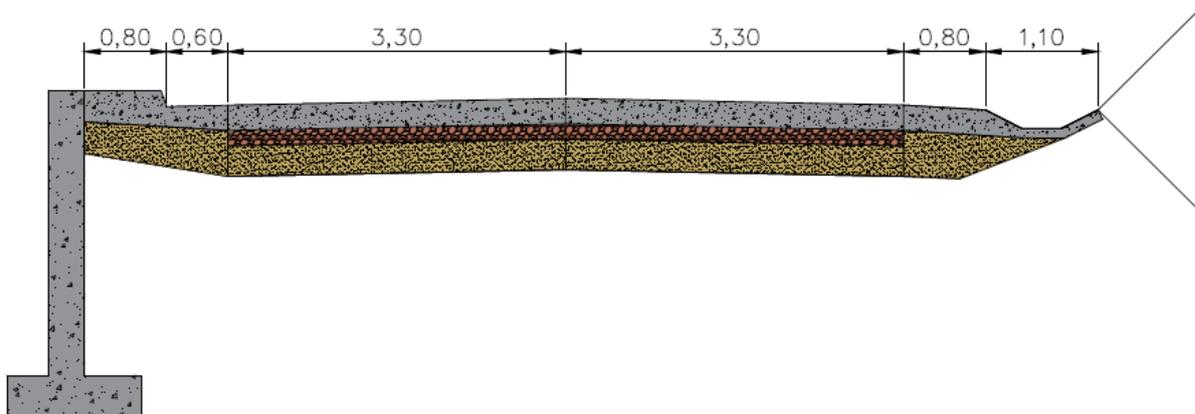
Esquema de sección transversal del camino principal con muro de contención. Fuente: elaboración propia.
